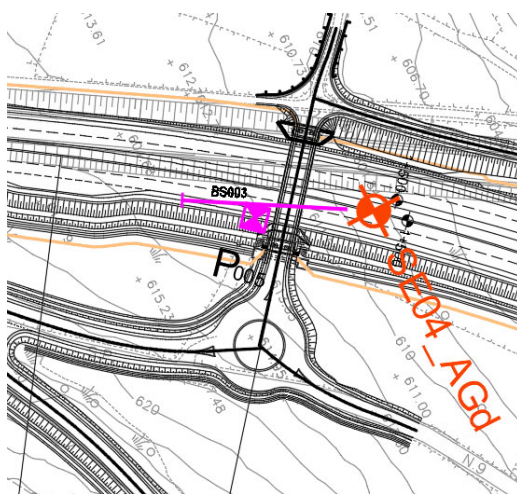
Stralcio della planimetria delle indagini per il sito di studio
